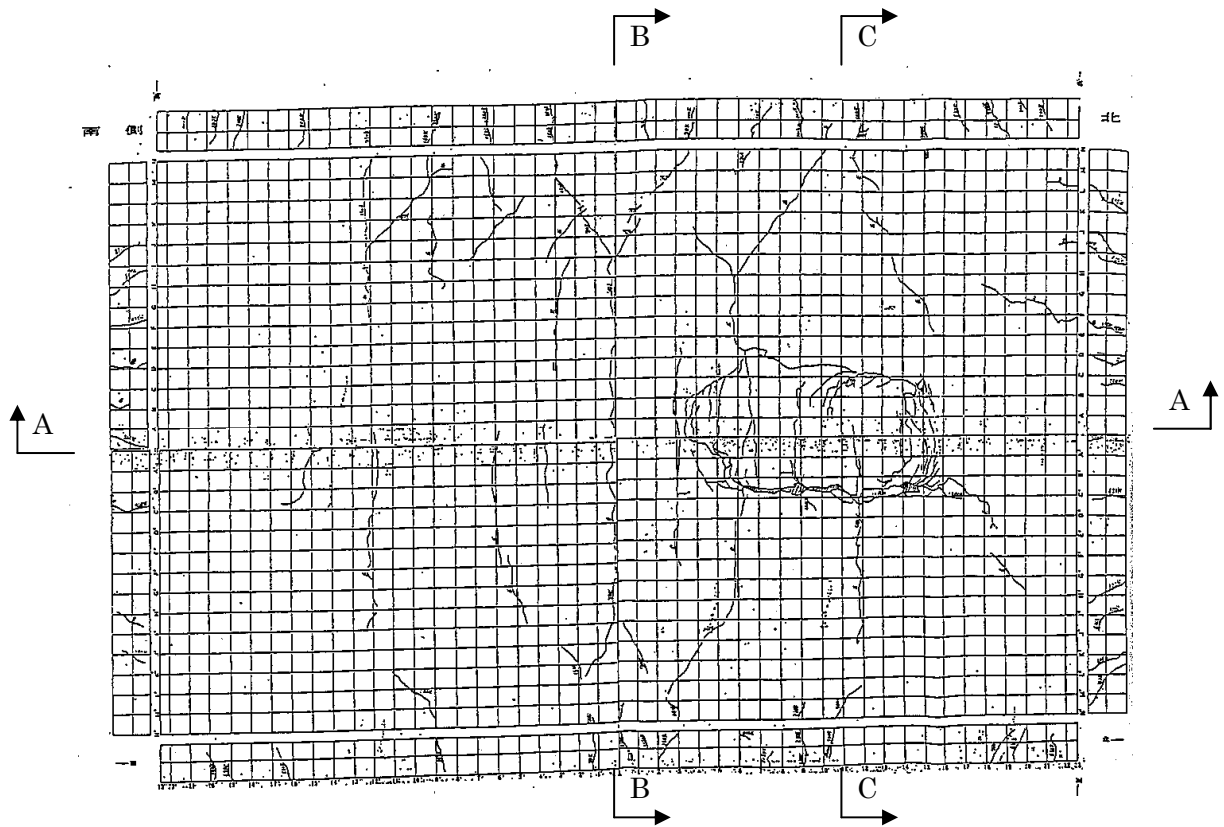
床版上面ひび割れ状況 (実験終了時)
